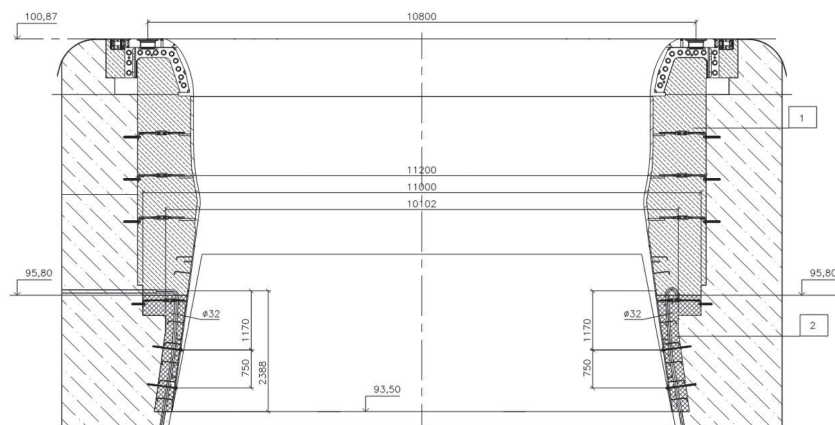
Камера рабочего колеса, переходный пояс и конус отсасывающей трубы ГА №2 Угличской ГЭС
